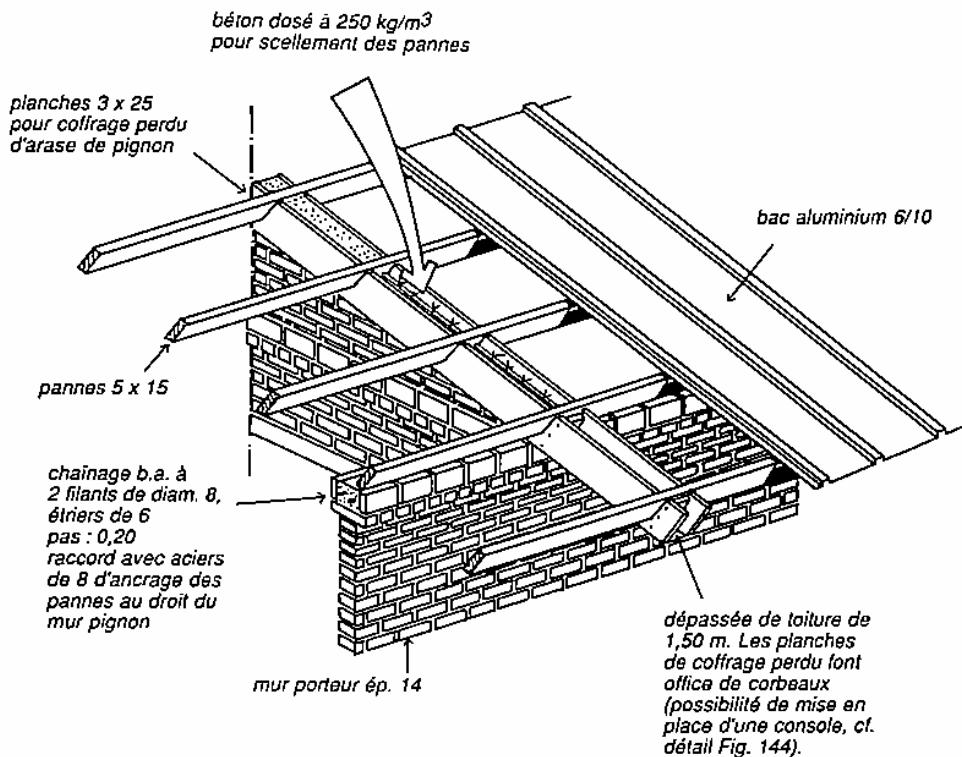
Projet d'habitat au Cameroun. Ancrage des pannes sur le mur pignon par un béton de scellement coulé en couronnement rampant du mur dans un coffrage perdu en planches.
